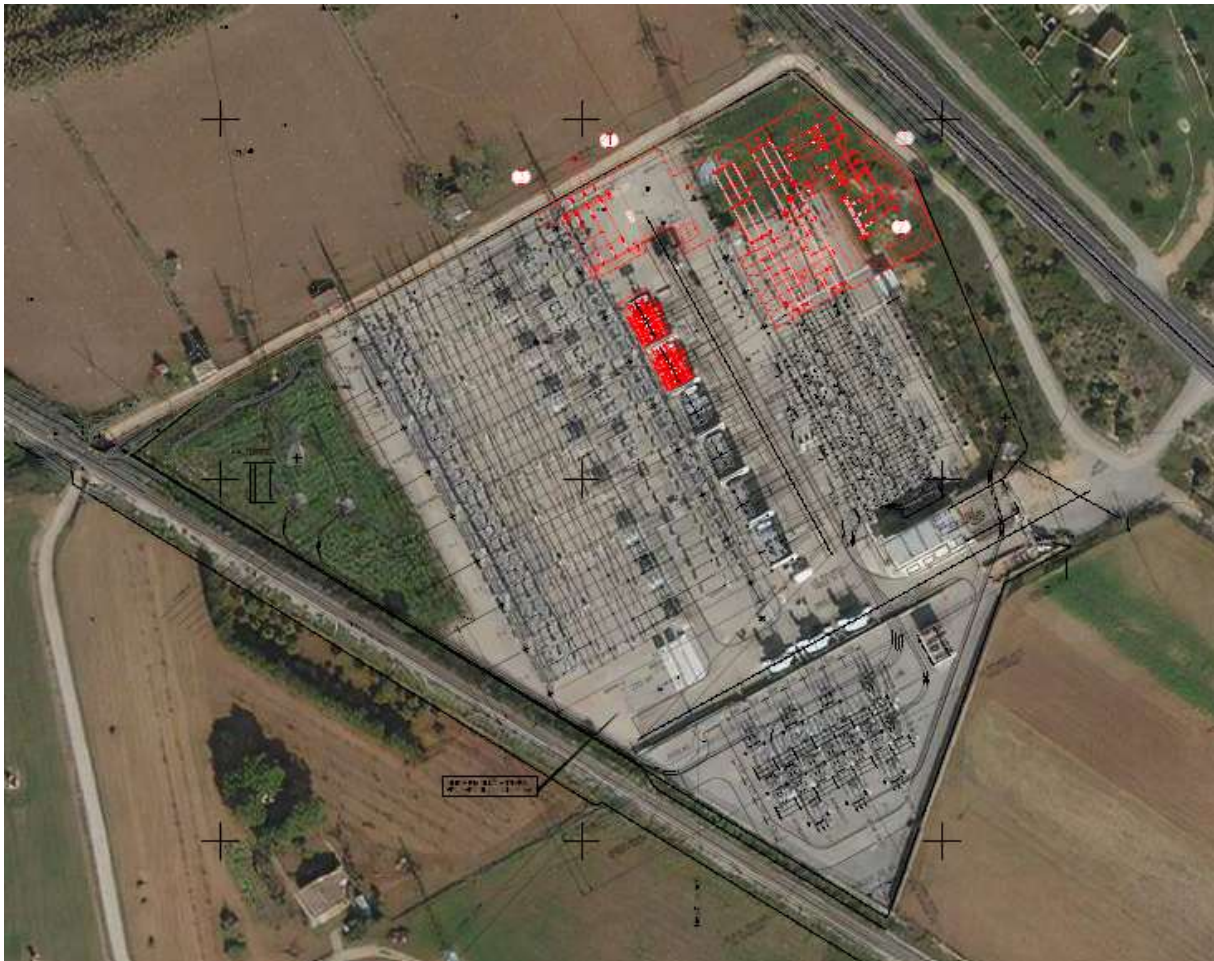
Plano Proyecto Implantación Futura. Instalación 220/132/66 kV ES Bessons y delimitación zona de ampliación.
